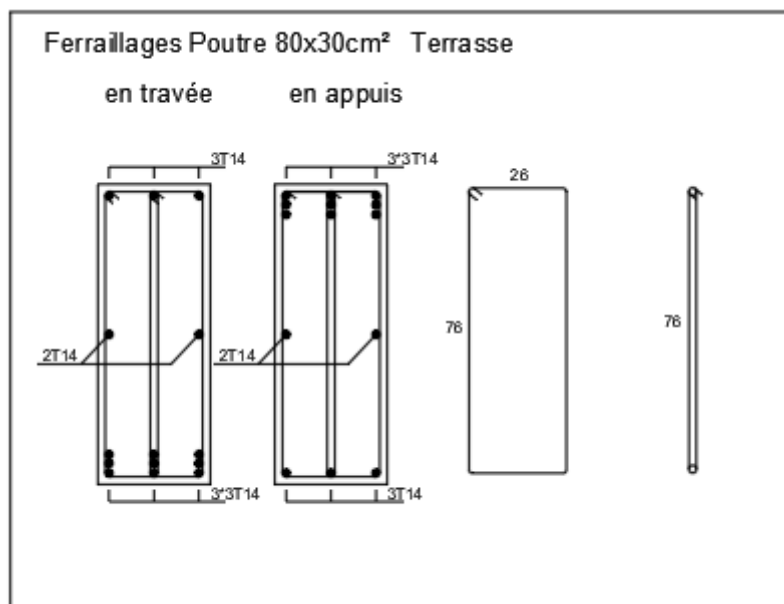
Schéma de Ferraillages poutre terrasse.
